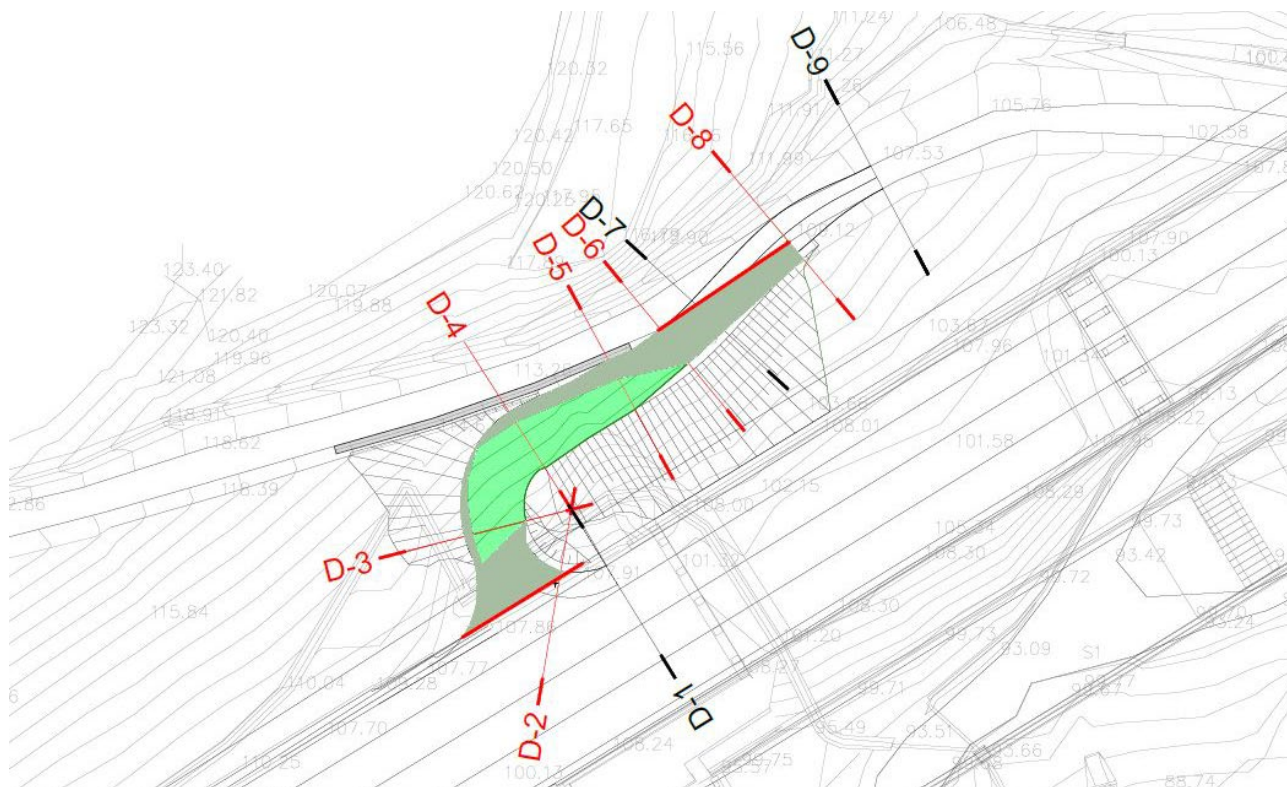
Planimetria VS001D con indicate le linee di sezione di riferimento
